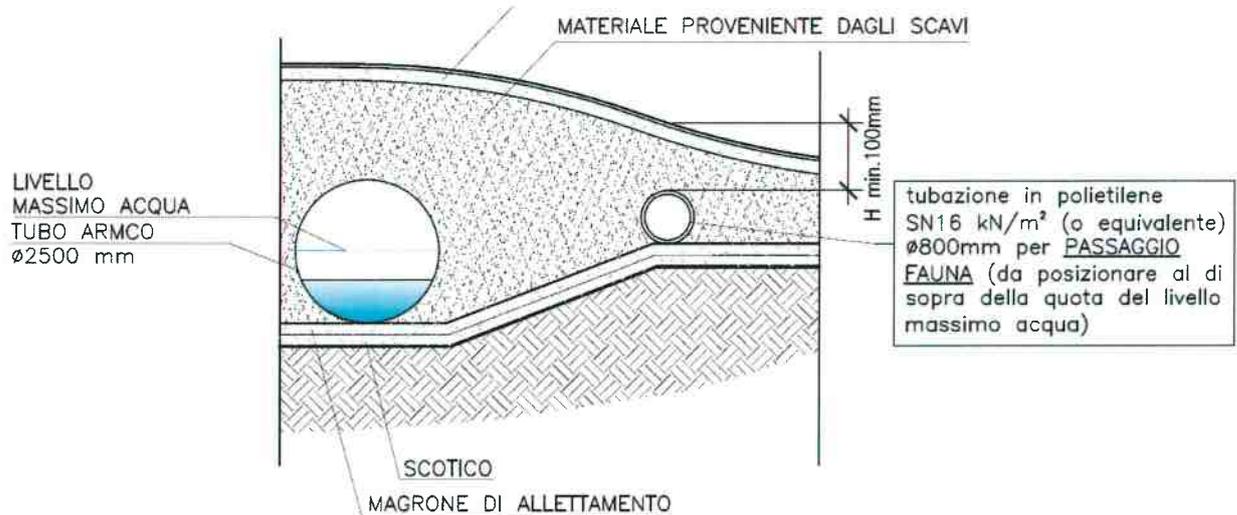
Sezione tipo guado provvisorio piste di cantiere.
